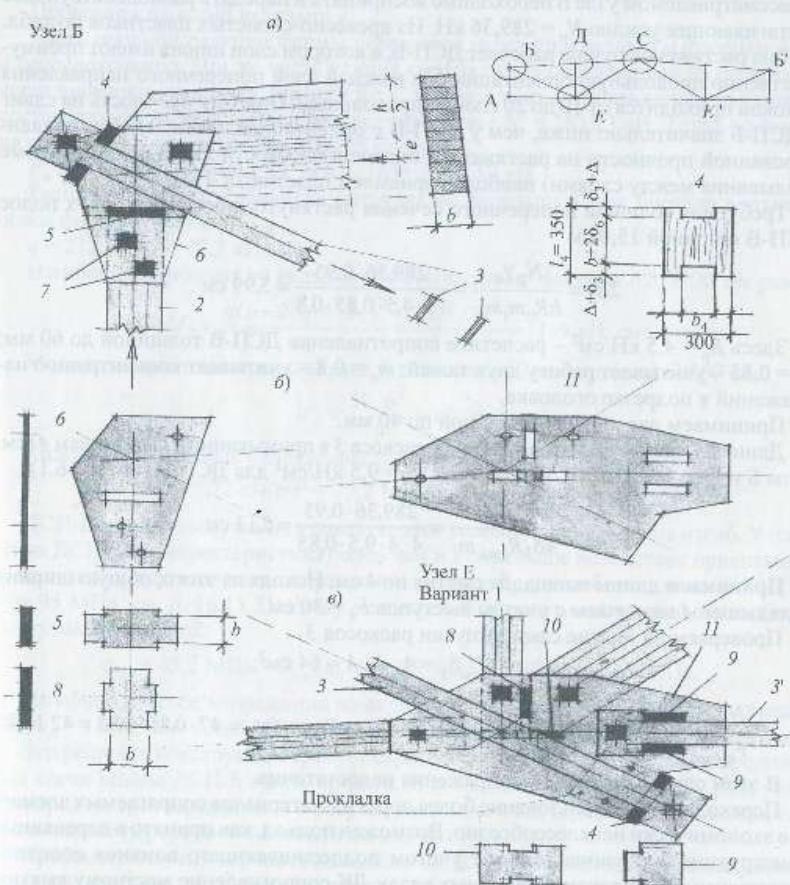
Безметалловая крупноблочная ферма из прямоделевых элементов: а — схема фермы и узел Б; б — детали узлов Б и Е из высокопрочных сплошных пластиков; в — узел Е с дополнительными деталями; 1 и 2 — клеммочные элементы ферм — сжато-изогнутые и сжатые; 3 — растянутый опорный раскос из высокопрочных пластиков; 4 и 10 — пластинчатые упорные вкладыши; 5 — опорная прокладка; 6 и 11 — узловые фасонки; 7 — стяжные болты; 8 — упорная прокладка; 9 — упорный вкладыш
